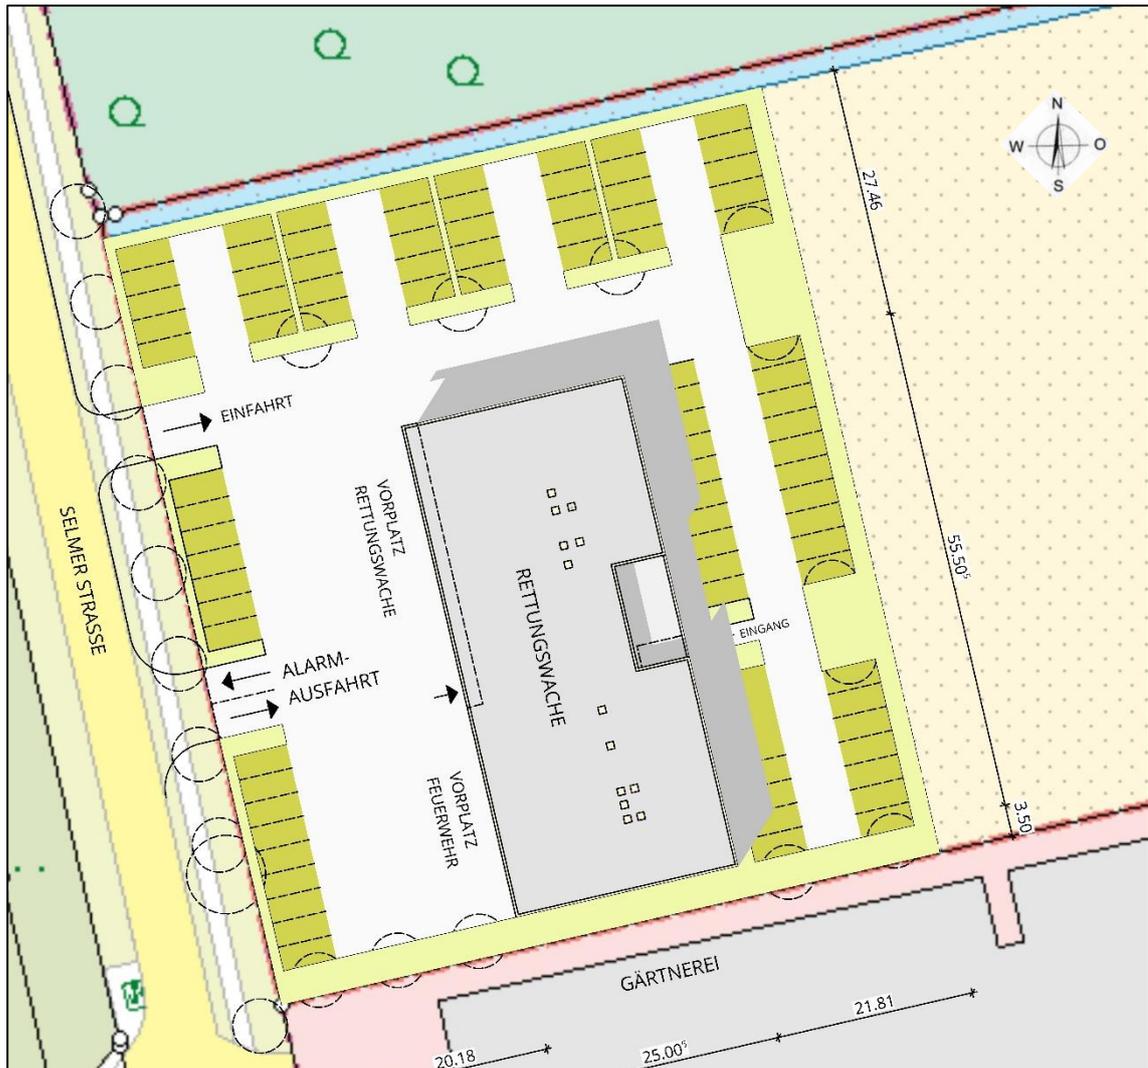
Lageplan zum Bauvorhaben (Stand 18.06.2021) /17/
